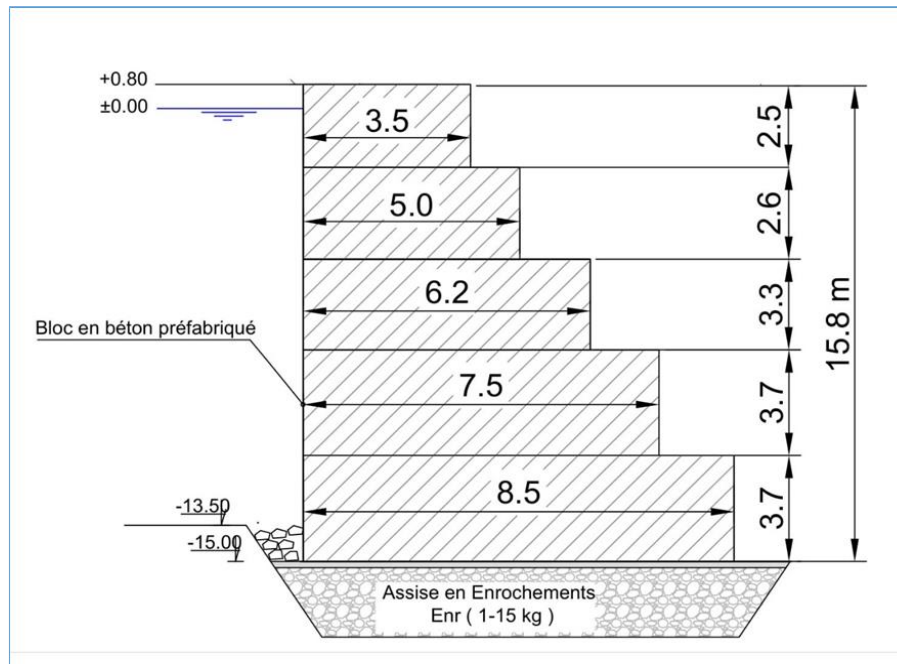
coupe transversale de la variante 1 (quai en blocs)
